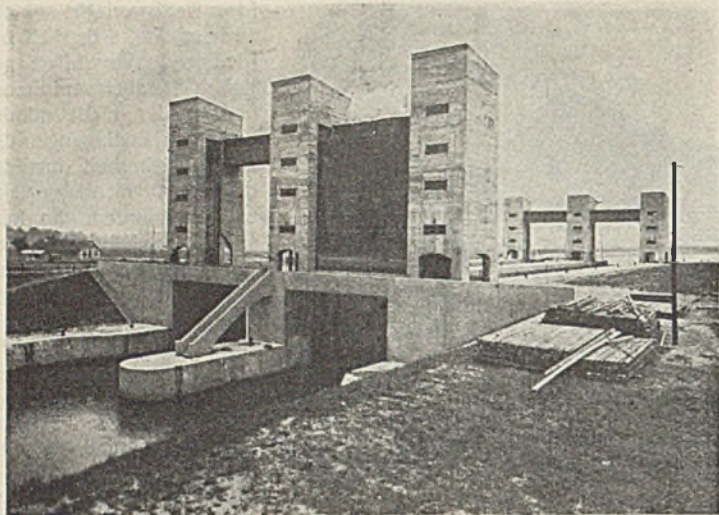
Staustufe Ladenburg, Schleusenanlage vom Unterwasser aus.
